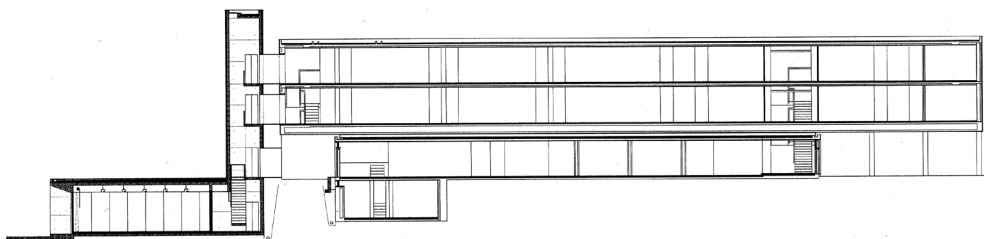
Corte longitudinal - Primeira proposta de intervenção.
